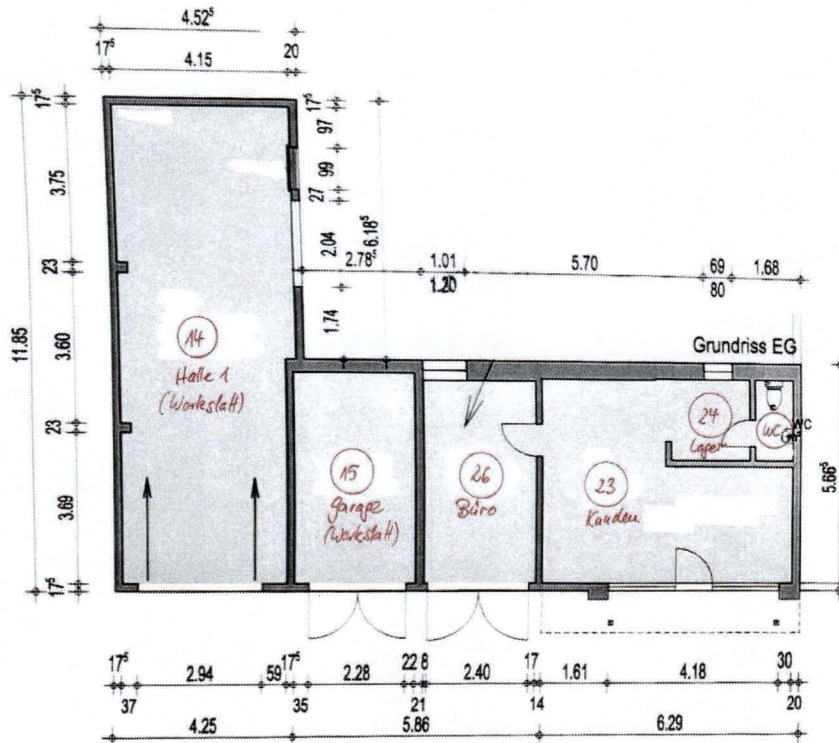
Grundriss Büro, Halle 1 und Garage 1 (EG, straßenseitig)
